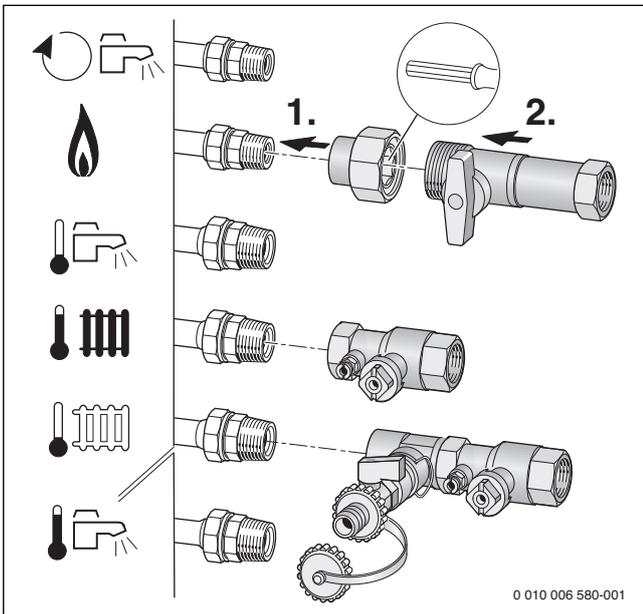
Montage des Armaturen-Sets am Beispiel Anschlüsse nach rechts AS-H1/Horizontales Anschluss-Set
